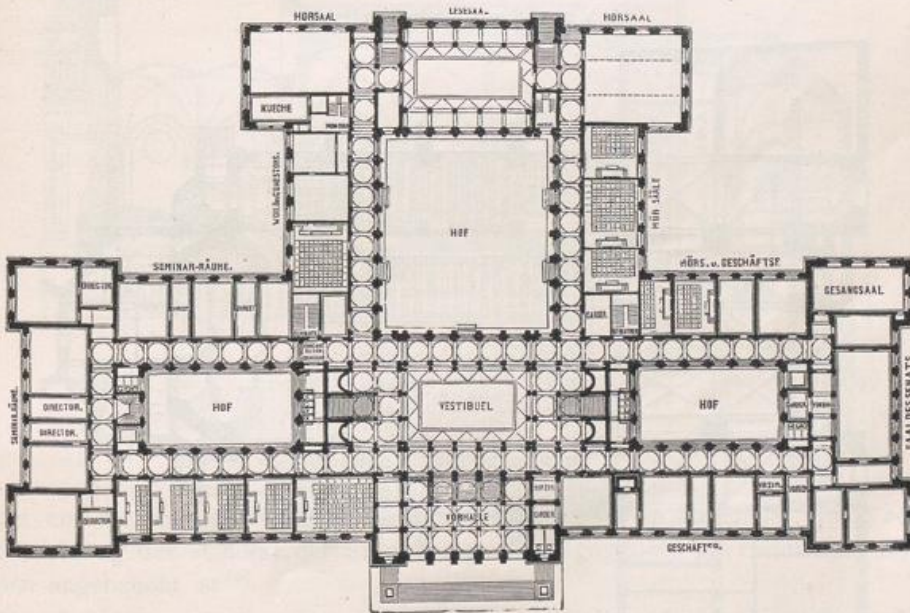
Grundriß des Universitätsgebäudes (Kollegienhaus) zu Straßburg. Architekt: Dr. O. WARTH.
